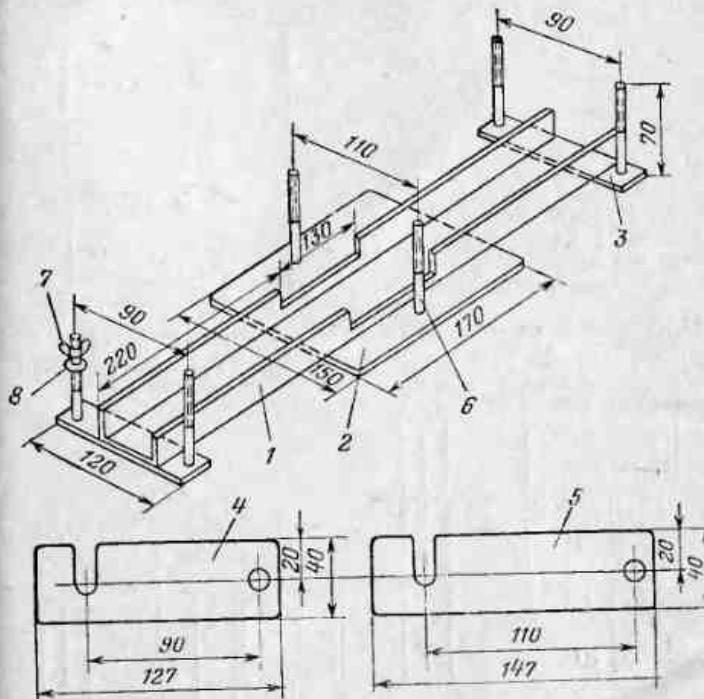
Монтажная накладка для усилениястыка секций при блочном монтаже шинопроводов ШОС67.
